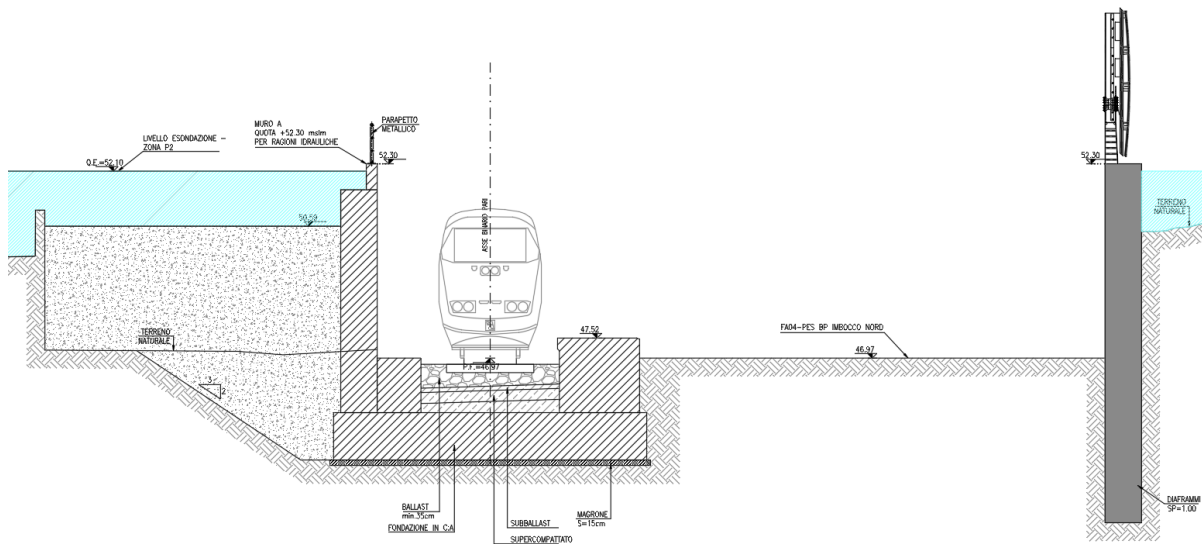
Sezione trasversale TR03 BP con indicazione quota di esondazione
